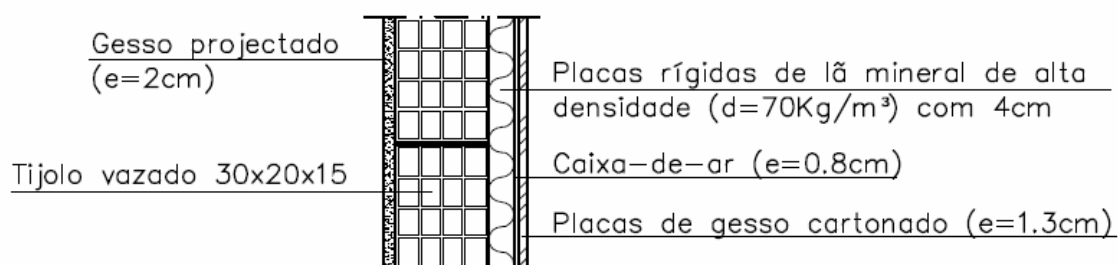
Pormenor construtivo da Parede interior de separação entre caixa de escada e habitação - Pi4
